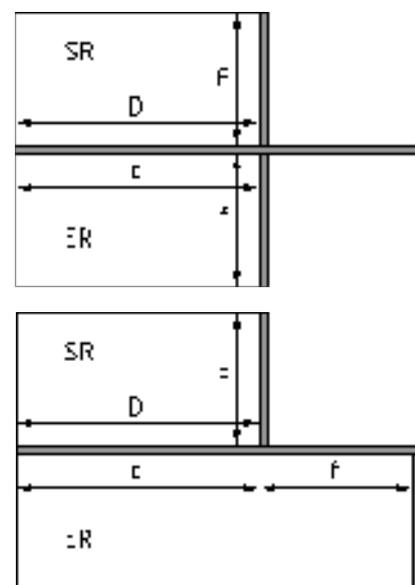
Abgewinkelte trennende und flankierende Bauteile, Grundriss
